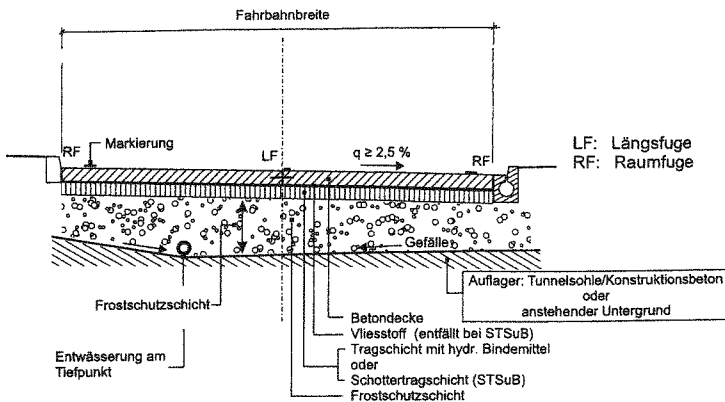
Regelausführung – Betondecke in einem Tunnel-/Trogbauwerk mit gleichem Deckenaufbau wie im Bereich der freien Strecke – Querschnitt
